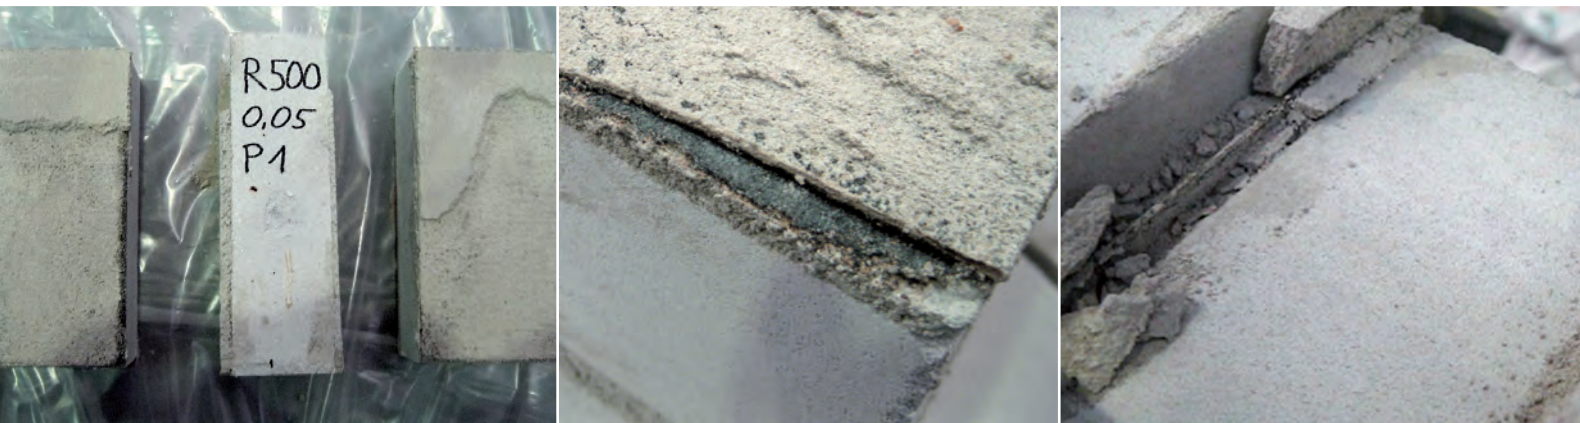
Mörtelbett mit eingelegter Mauersperrbahn
